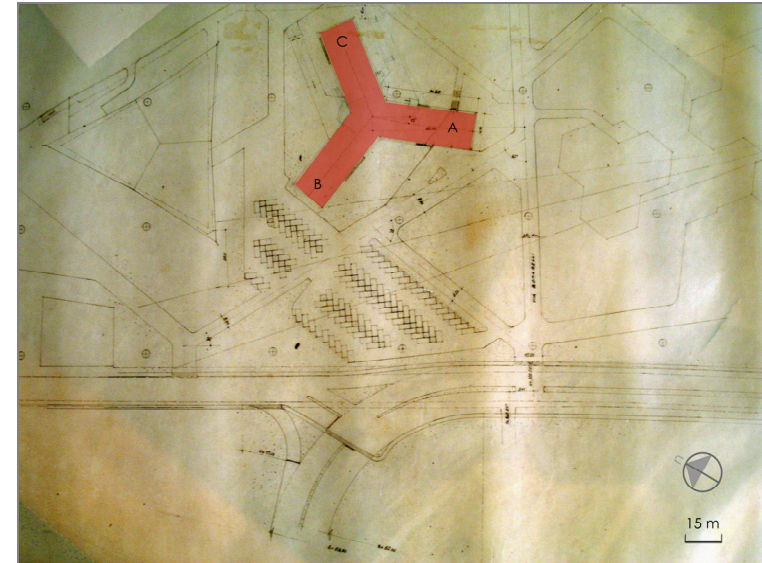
planimetria generale (fonte CSAC – stralcio tav. 5, archivio n. 234-2, rielaborazione f.m.)
